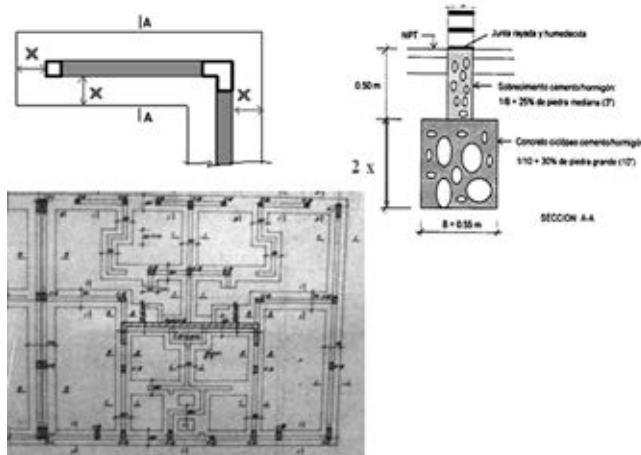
Cimentación corrida de concreto ciclópeo.
